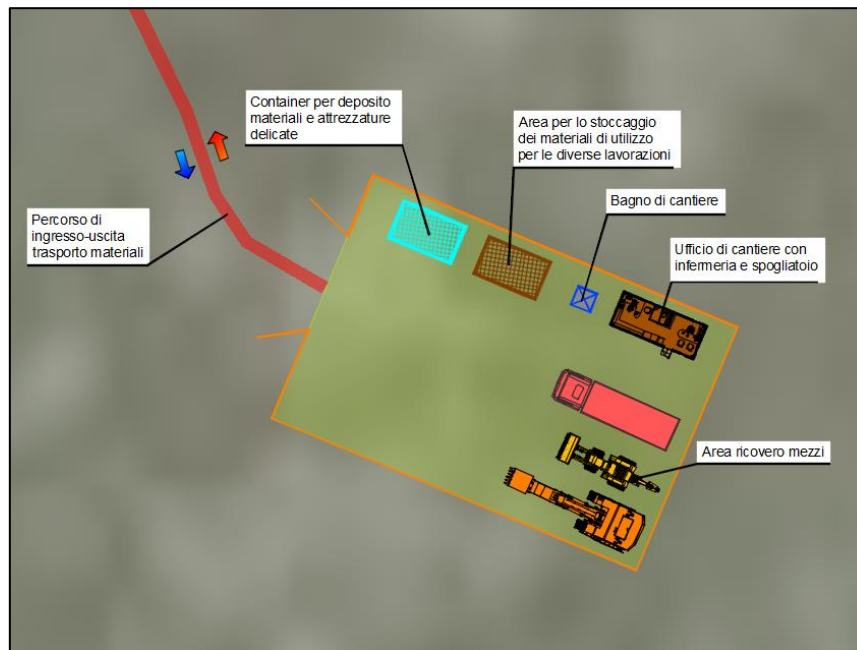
DETTAGLIO AREA STOCCAGGIO MEZZI DI CANTIERE
